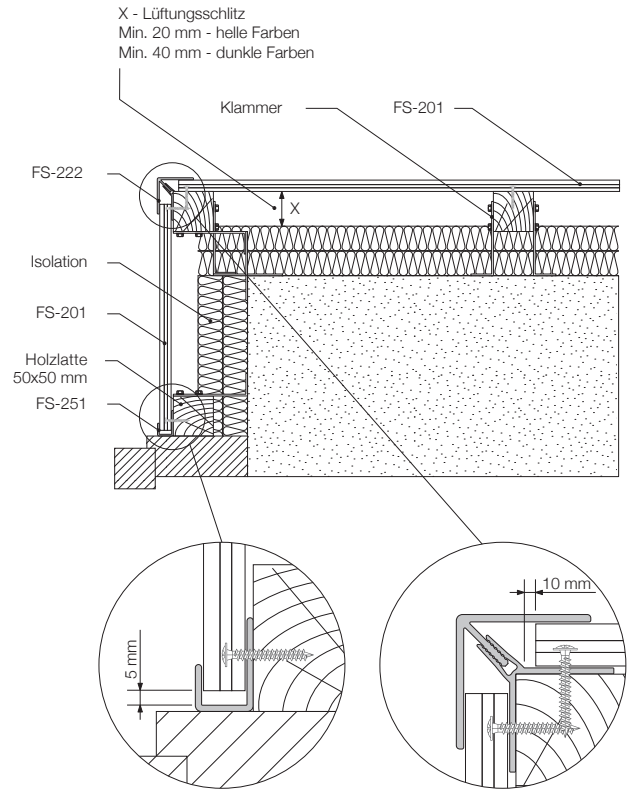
KERRAFRONT Detail, Ecke, Holzelemente an der Mauer mit Wärmedämungsschicht – horizontaler Schnitt
